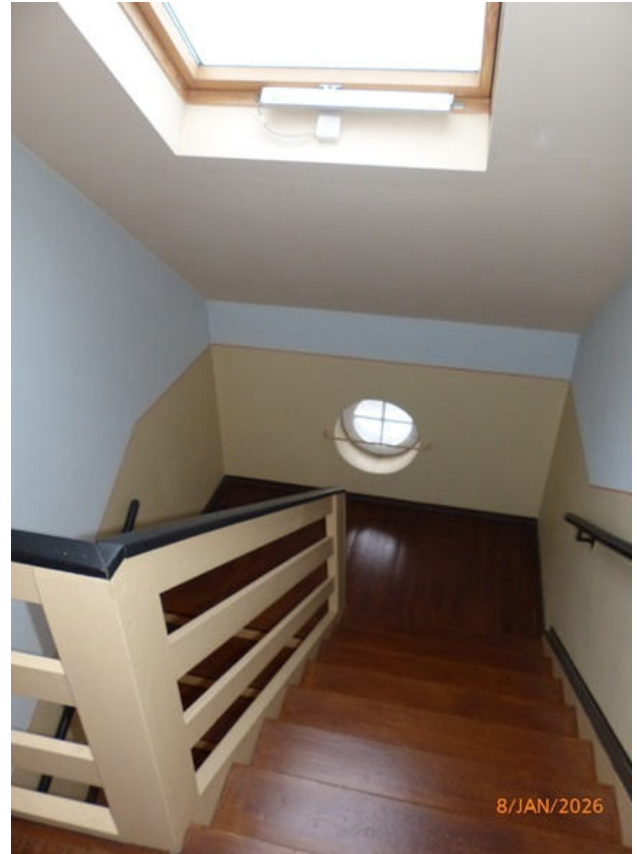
und 13: Treppenhaus im Erdgeschoss Slevogtstraße 18 (GE)
